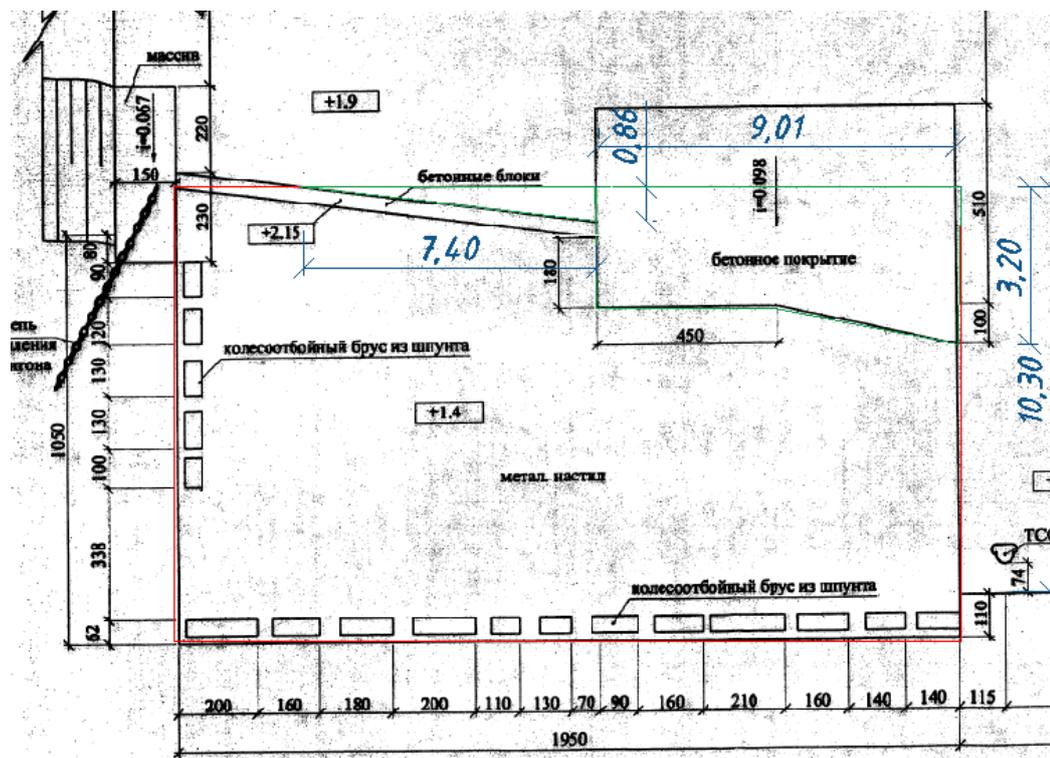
Обоснование к схеме демонтируемых железобетонных элементов-1.
